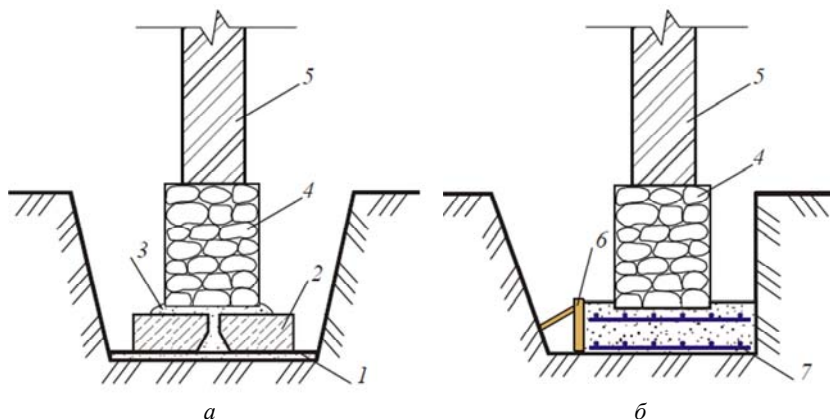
Уширение подошвы фундамента путем подводки монолитных или сборных железобетонных плит:
